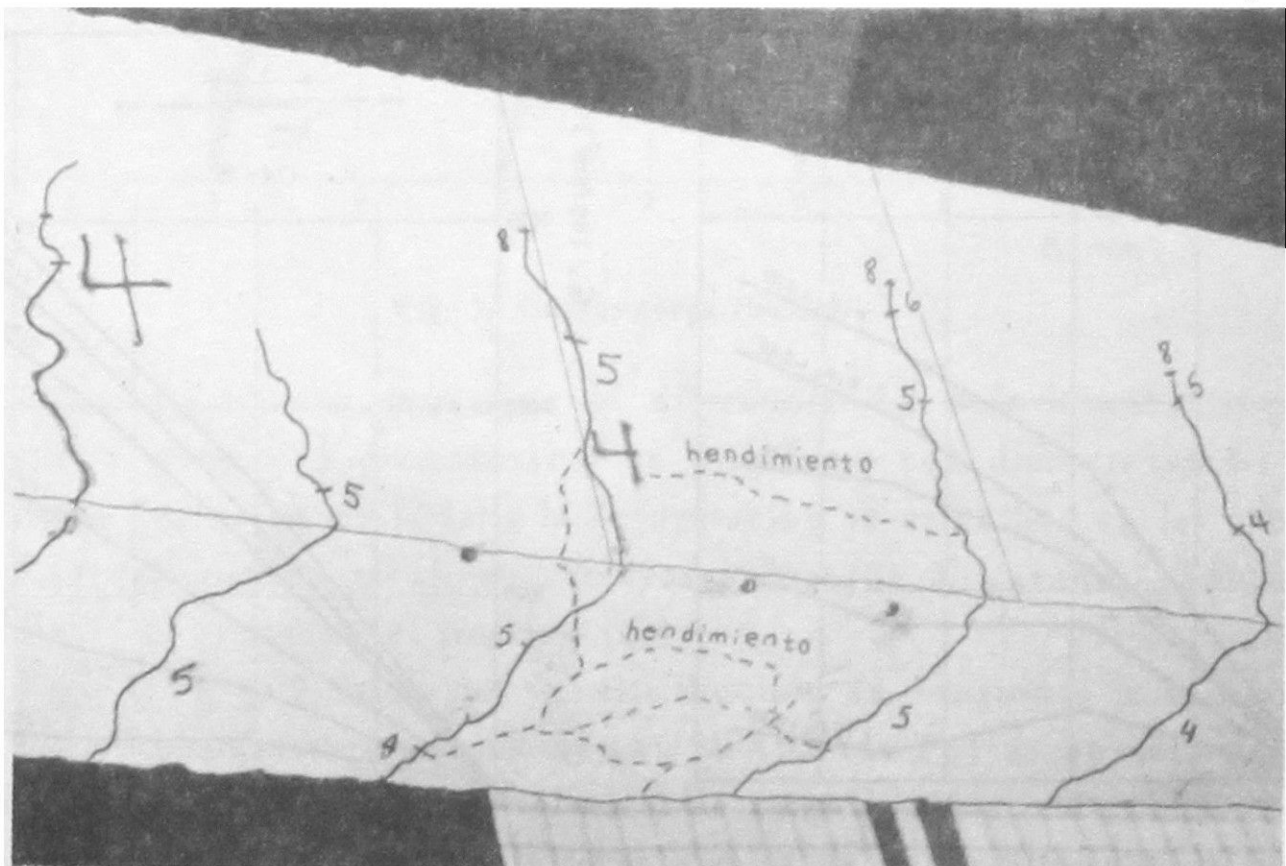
Estado de agrietamiento final. Viga s1-3:  $l_s = 24 \text{ cm}$
